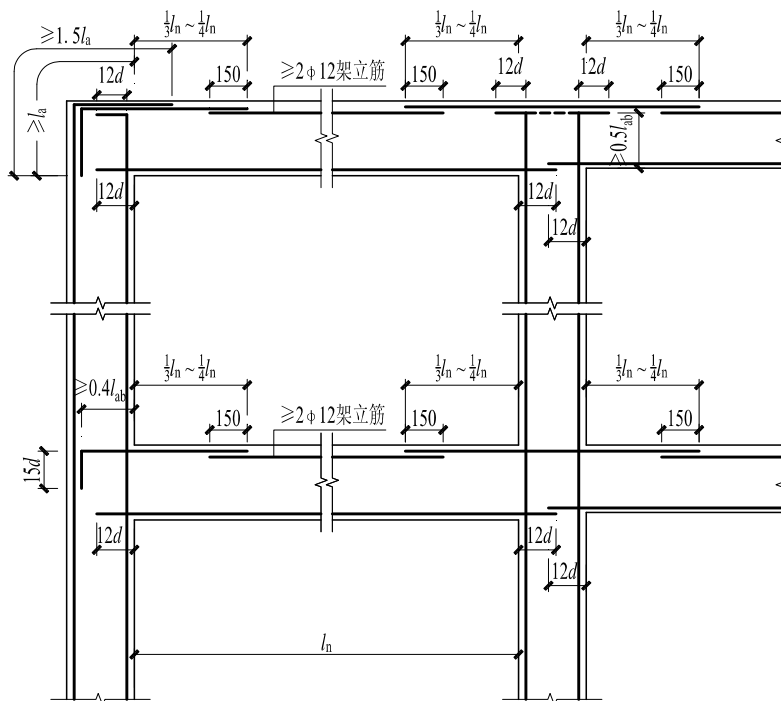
非抗震设计时框架梁、柱纵向钢筋在节点区的锚固要求
